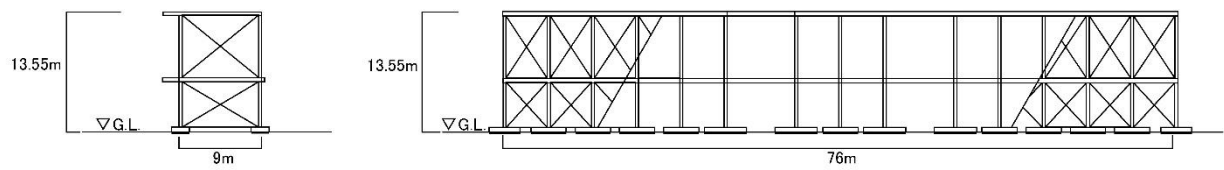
(4) 断面図 (E 設備架台、G 設備架台)
